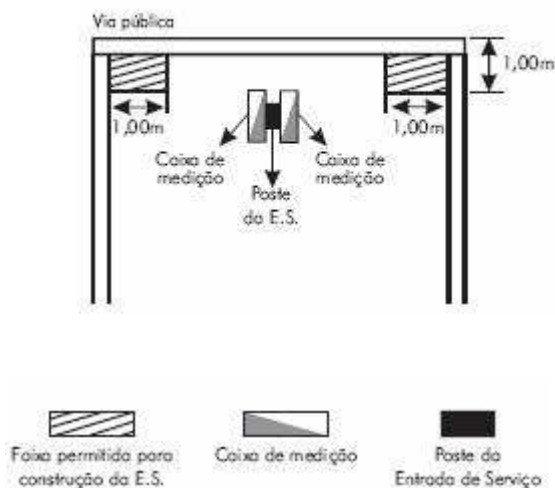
Faixa Permitida para Construção - Tipos 2E e 3E
